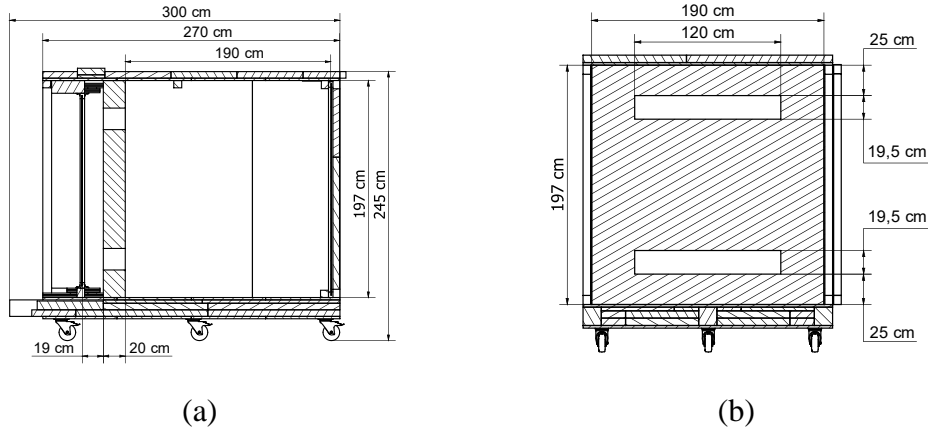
Dimensions de la maquette : (a) Coupe latérale, (b) Vue de face
